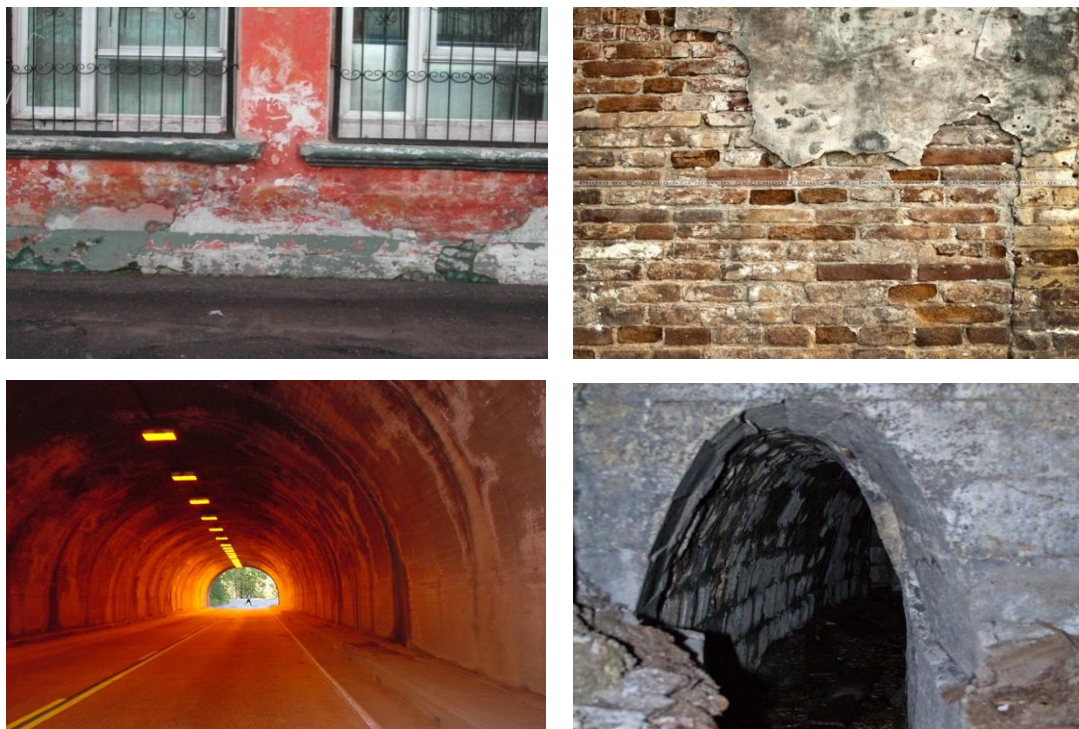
Примеры разрушающего воздействия воды на фасады и подземные сооружения
